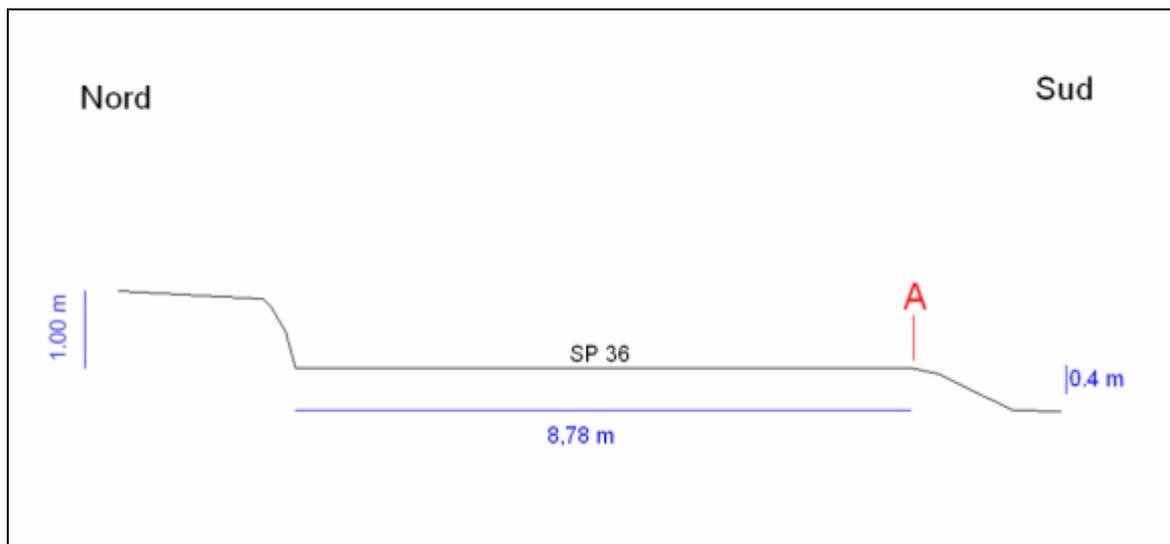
Sezione schematica del tratto stradale di interesse (SP 36)
